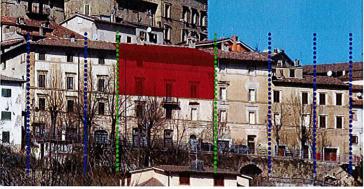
\_Individuazione del primo assetto del Palazzo Organtini(tratteggio verde) con la sopraelevazione della porzione centrale dell'isolato.
